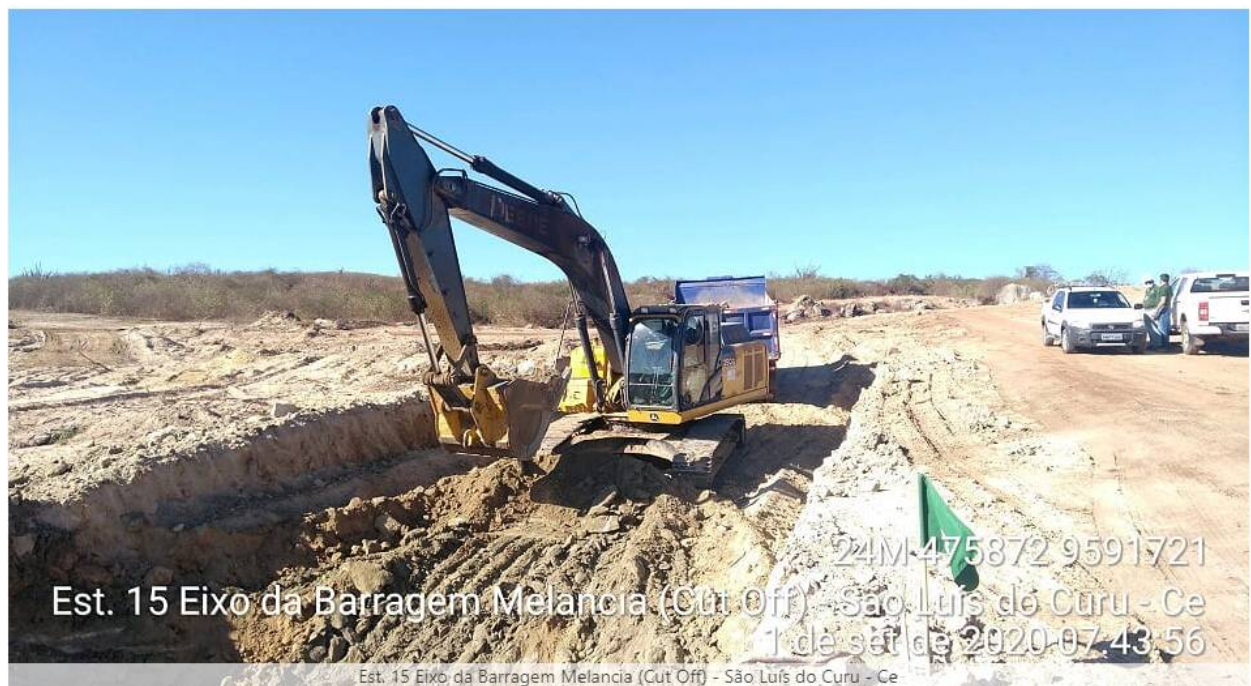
Escavação no barramento principal (cut-off. Est.15)
